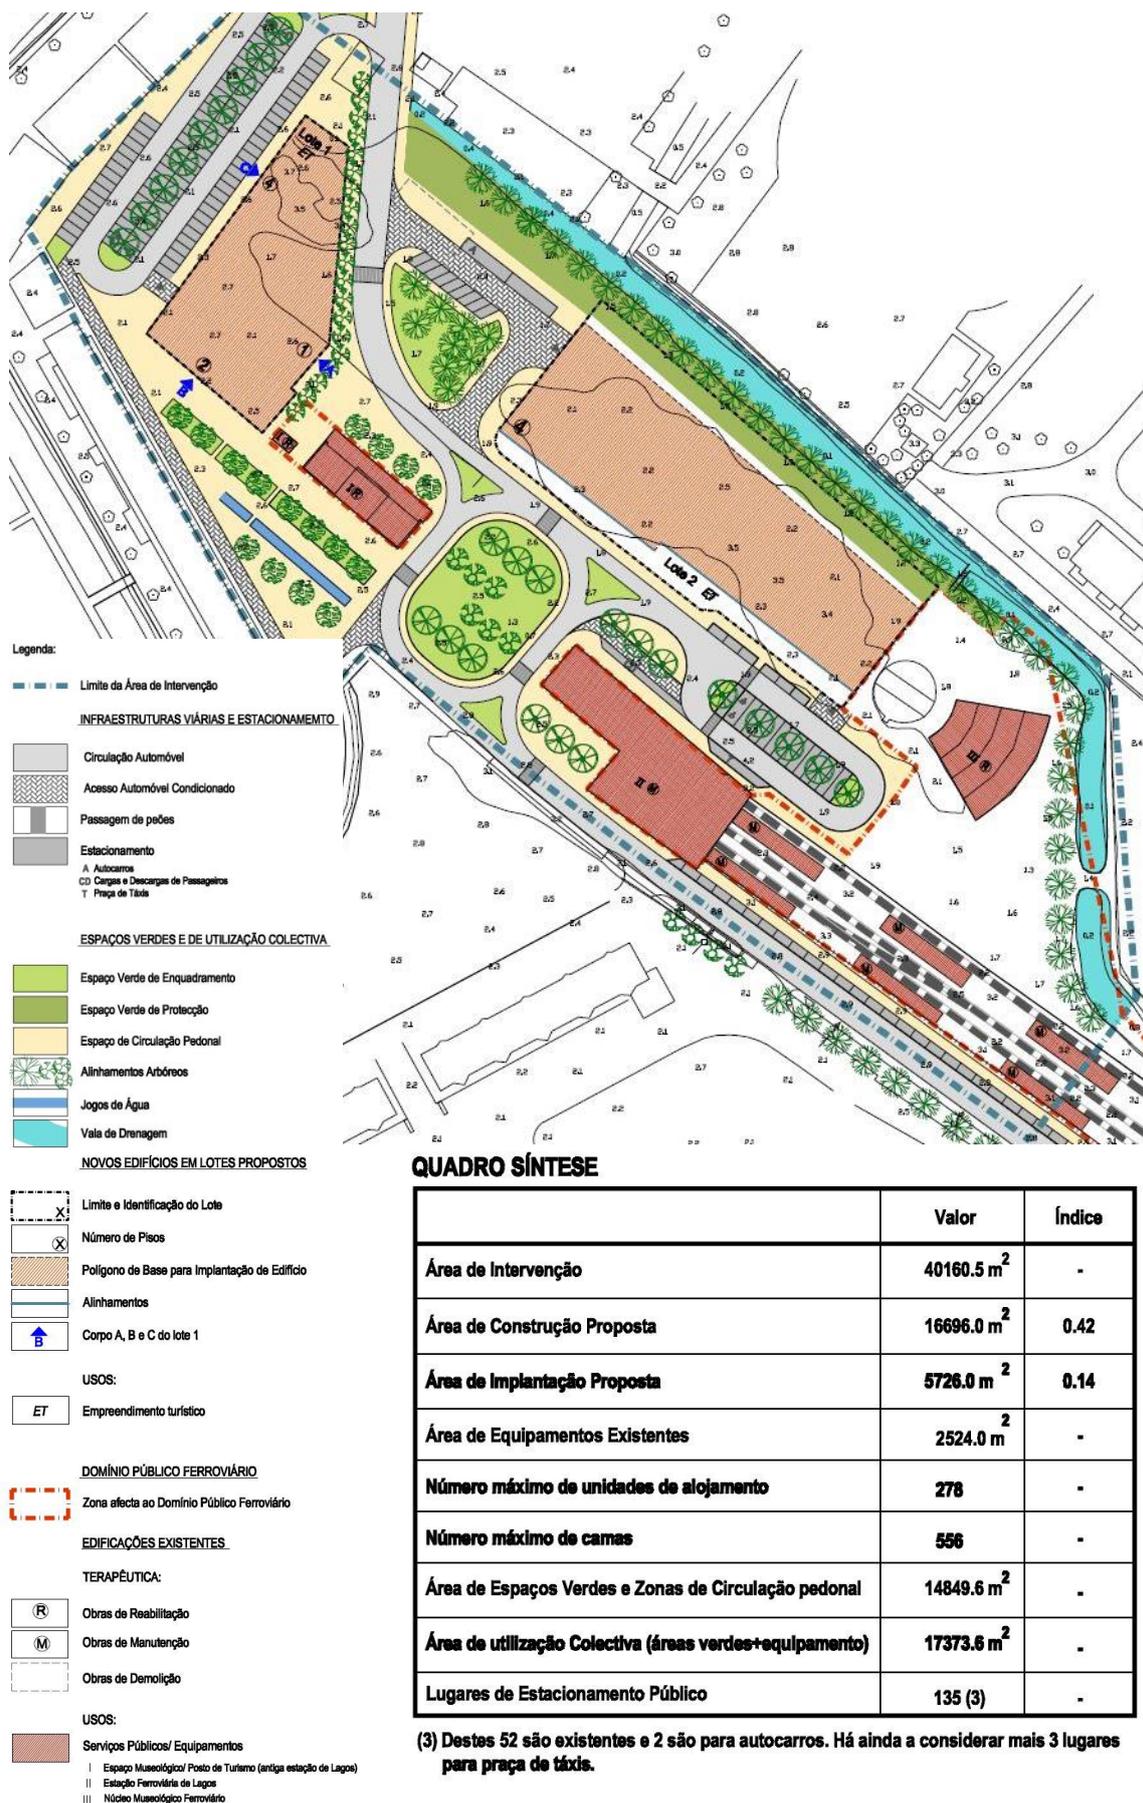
Planta de Implantação do Plano de Pormenor de 2008 referente ao Espaço Ferroviário de Lagos.
